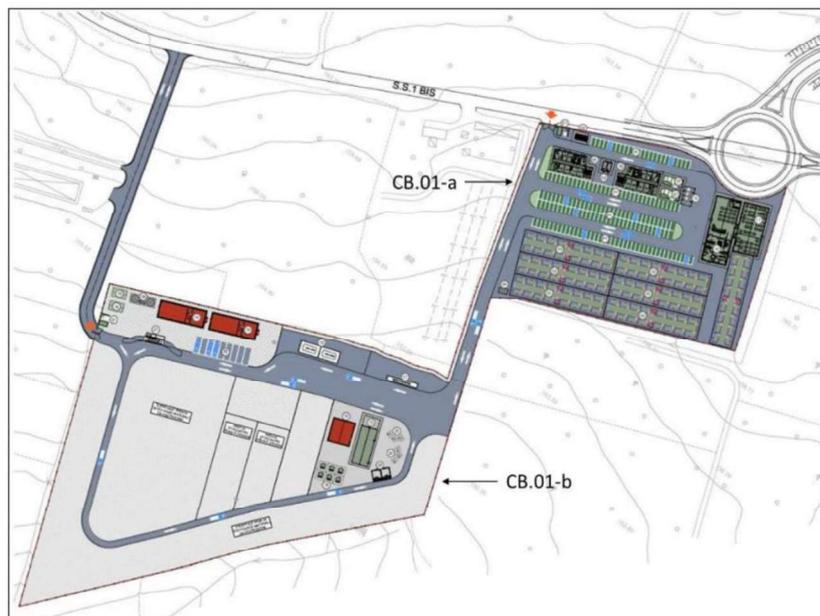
Planimetria di dettaglio del campo base CB\_01
